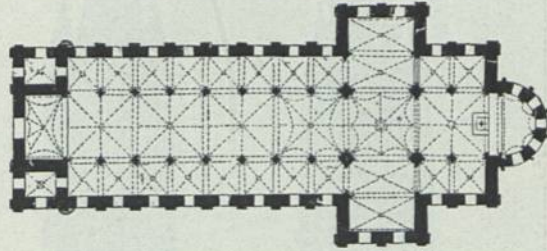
Grundriss von S. Trinité in Caen (restauriert)
